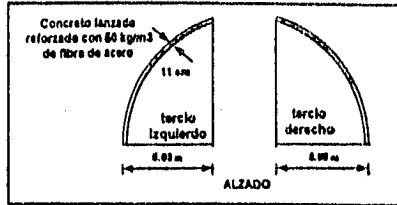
Colocar concreto lanzado, reforzado con fibras de acero, hasta alcanzar un espesor de 11 cm.
